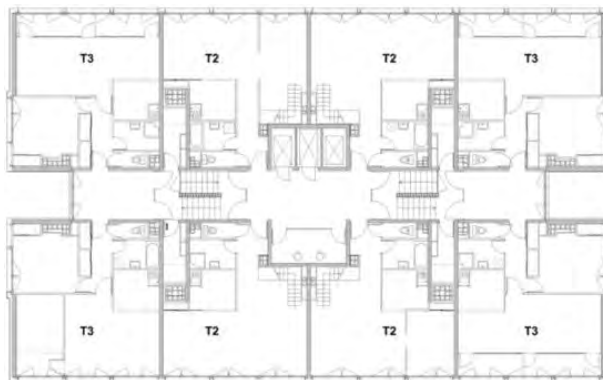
Planta existente de la torre Bois-Prêtre, 1990
